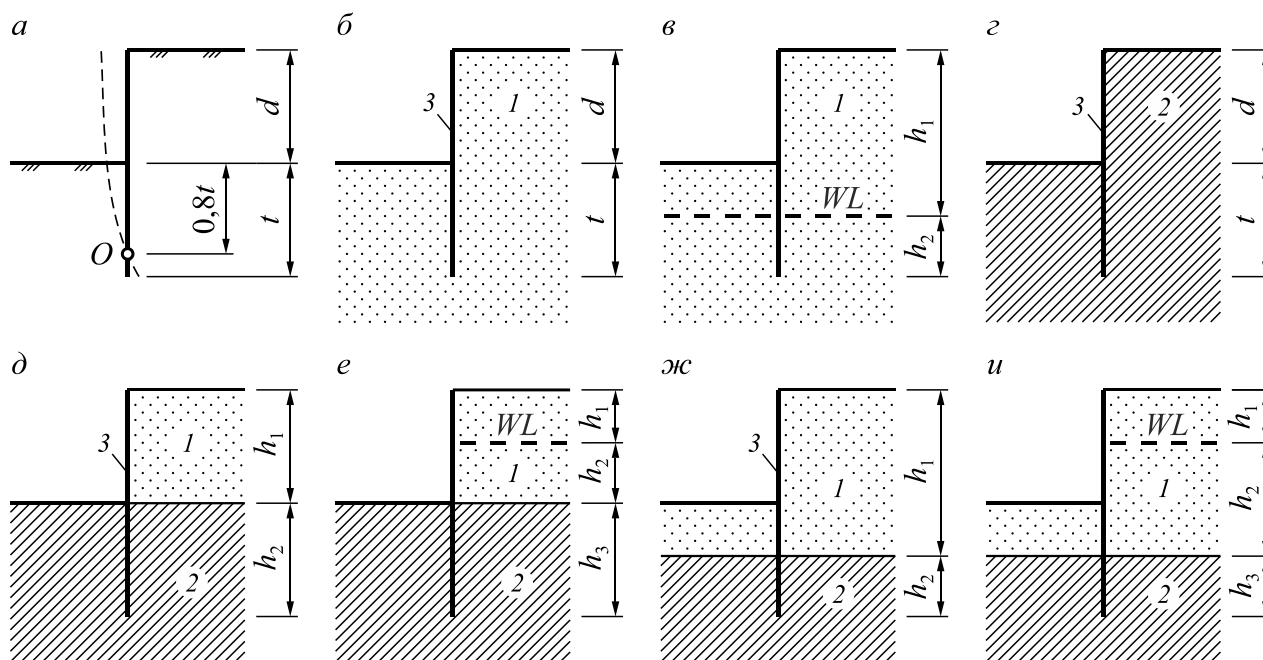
Схема деформирования консольной шпунтовой стенки (а) и варианты
